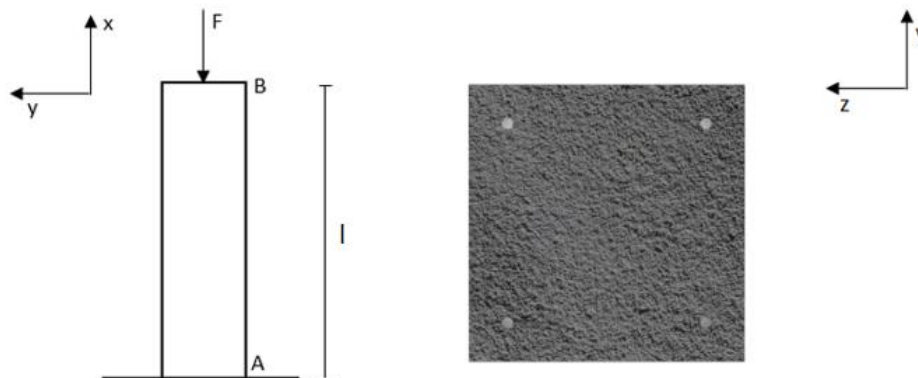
Columna de hormigón armado sometida a compresión, sección transversal y condiciones de contorno.
